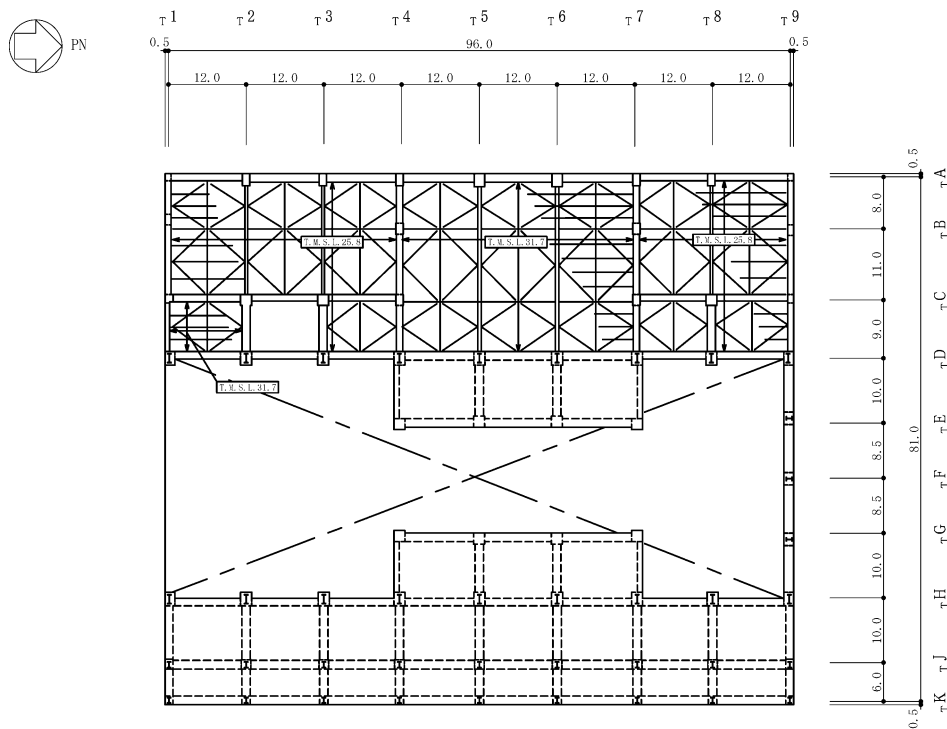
タービン建屋の概略平面図 (3F, T.M.S.L. 30.9m) (5/6) (単位 : m)
